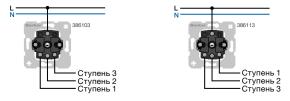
Трехступенчатый выключатель с нулевым положением [№ для заказа 3861 03] / трехступенчатый выключатель без нулевого положения [№ для заказа 3861 13]
